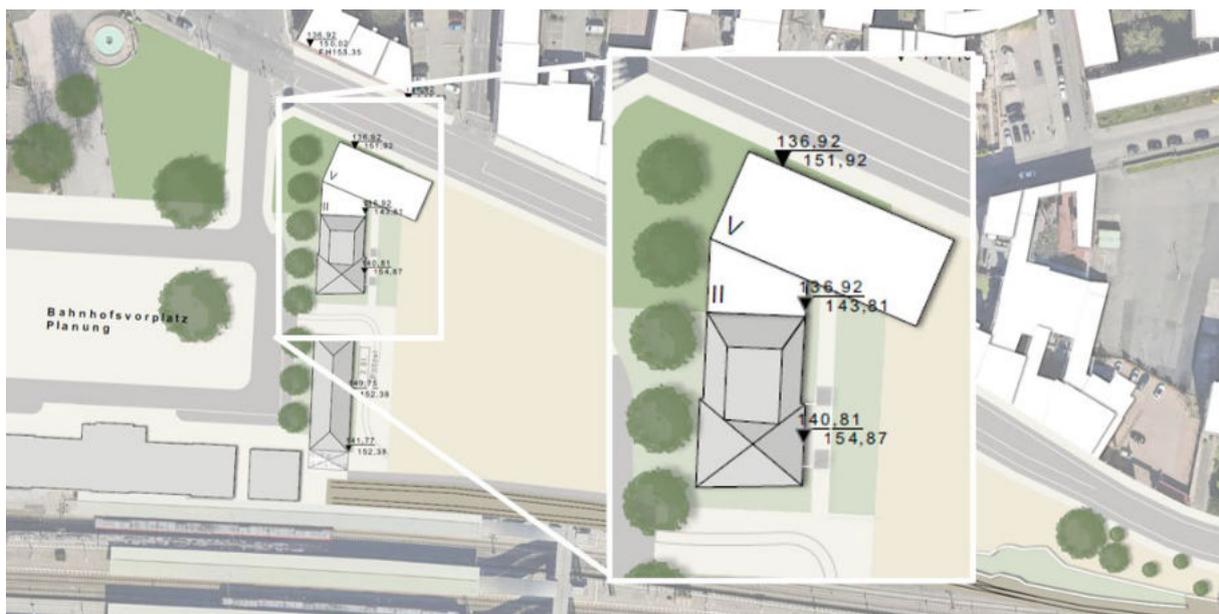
Entwurfsvariante 2.5 - Baufeld West - Fortführung der Bestandsbebauung, verkürzte Zeilenstruktur Landauer Straße
